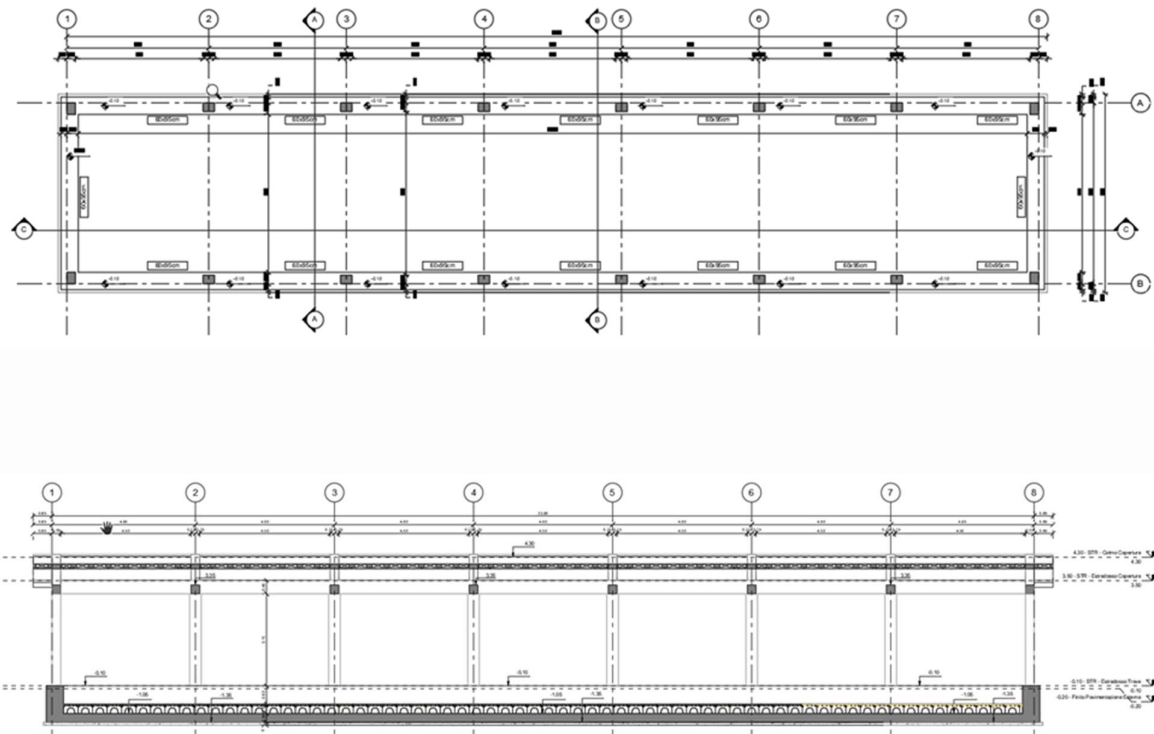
Pianta e sezione longitudinale del fabbricato FA02
